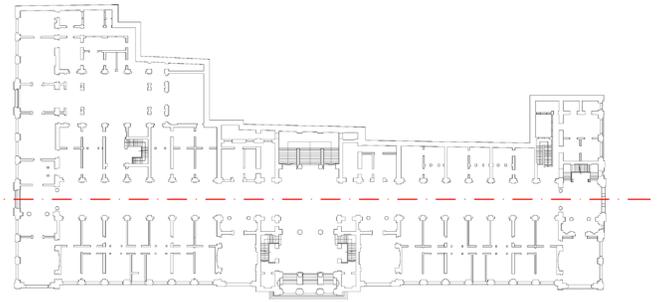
Simetría en planta Palacio de Tribunales. Elaboración propia
